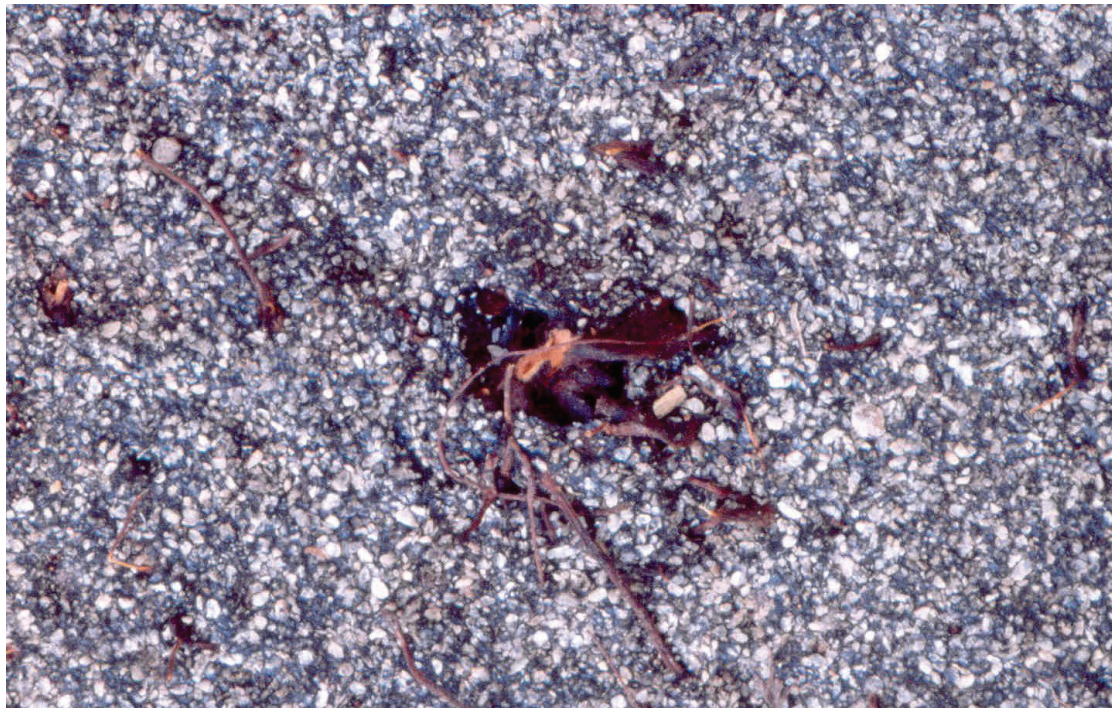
Oberfläche der Bahn mit Wurzeleindringungen (Detail)
